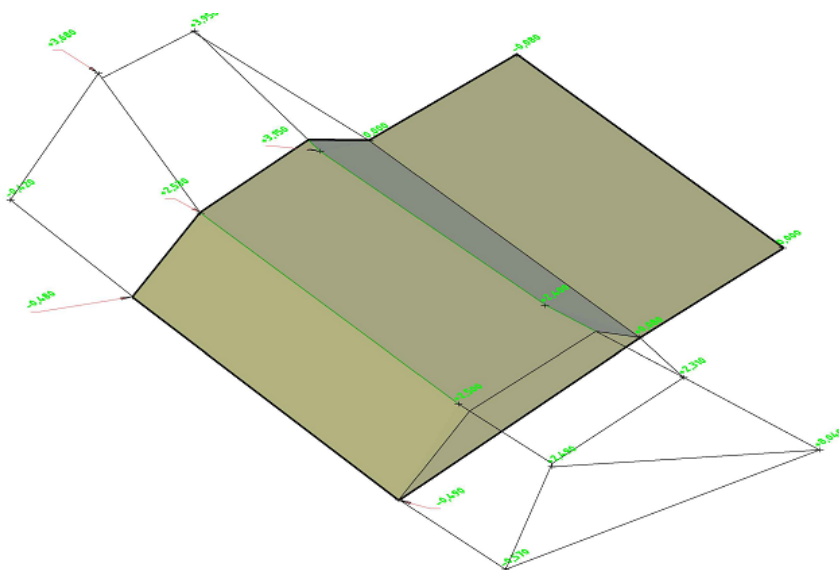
Съемка загрузки плиты защитного экрана грунтом при проведении испытаний
